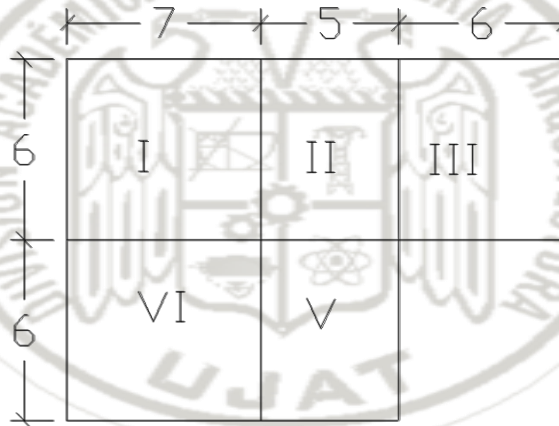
Planta de losa de azotea (s/e acota. m)
